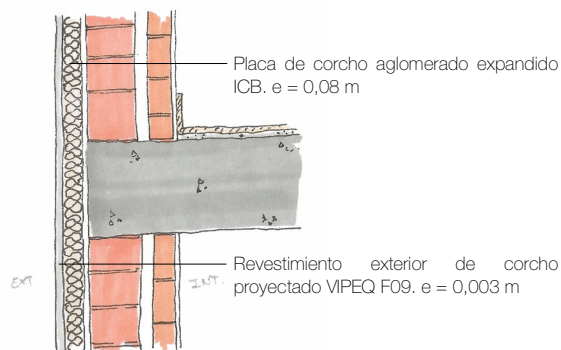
Sistema SATE. Encuentro pared de fachada con forjado (autoría propia).
